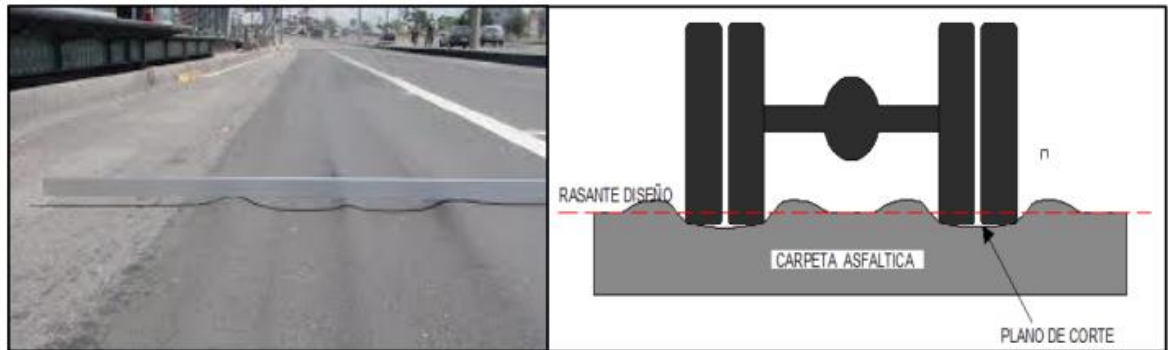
1: Ahuellamiento en pavimentos asfálticos.
